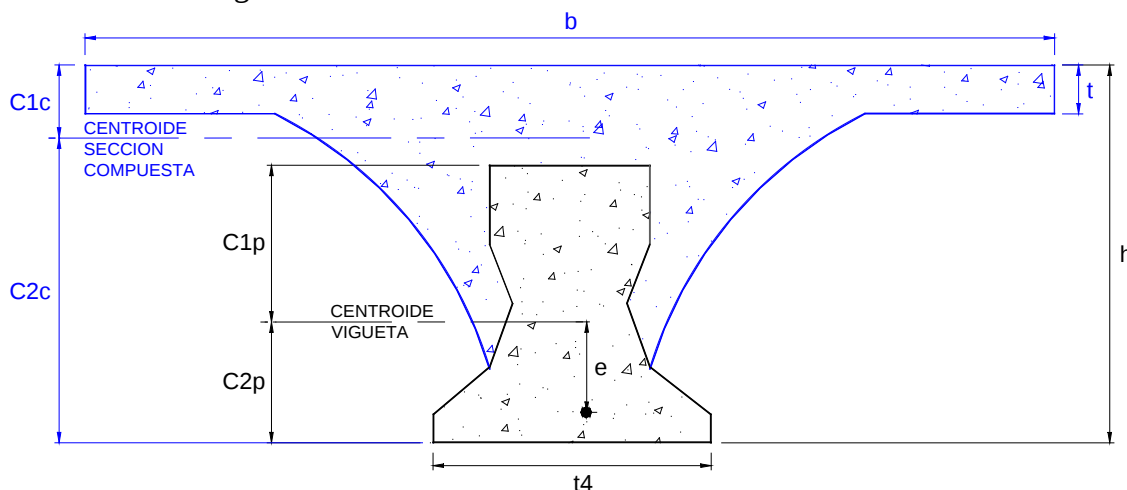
Sección compuesta: vigueta pretensada más la losa vaciada en el lugar.
